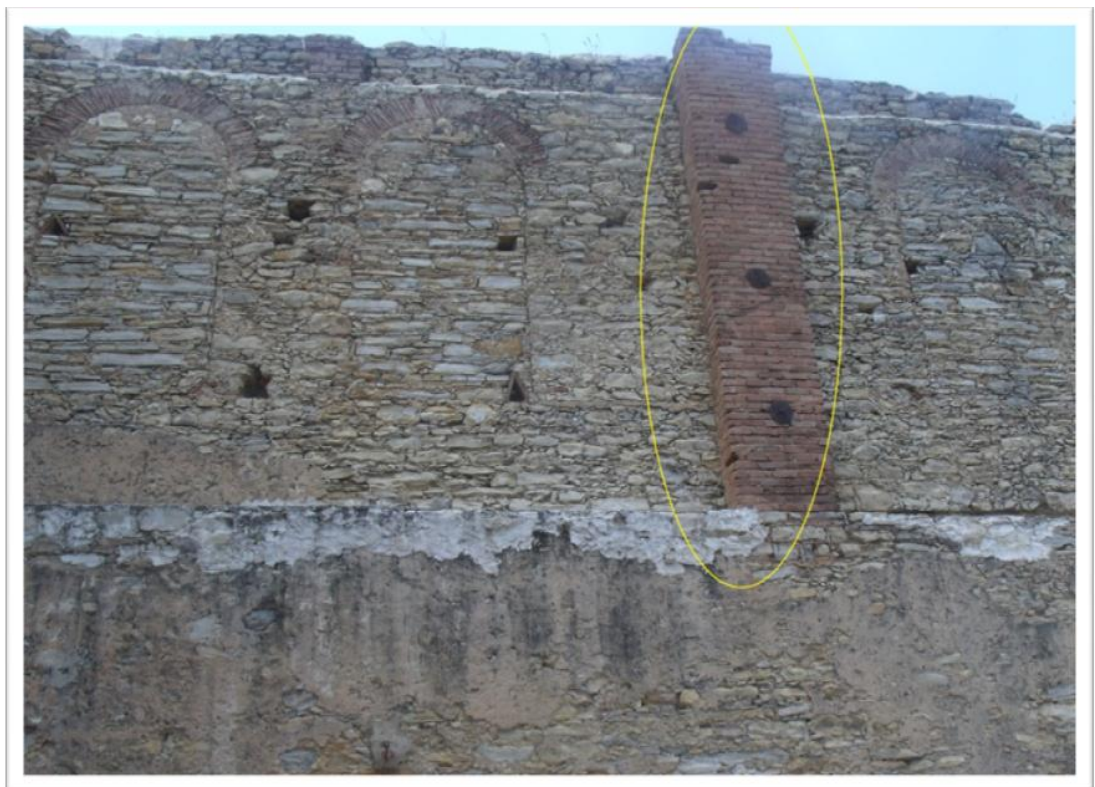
Pilar em tijolo. Fachada oeste. Foto: Marcia Rodrigues.
